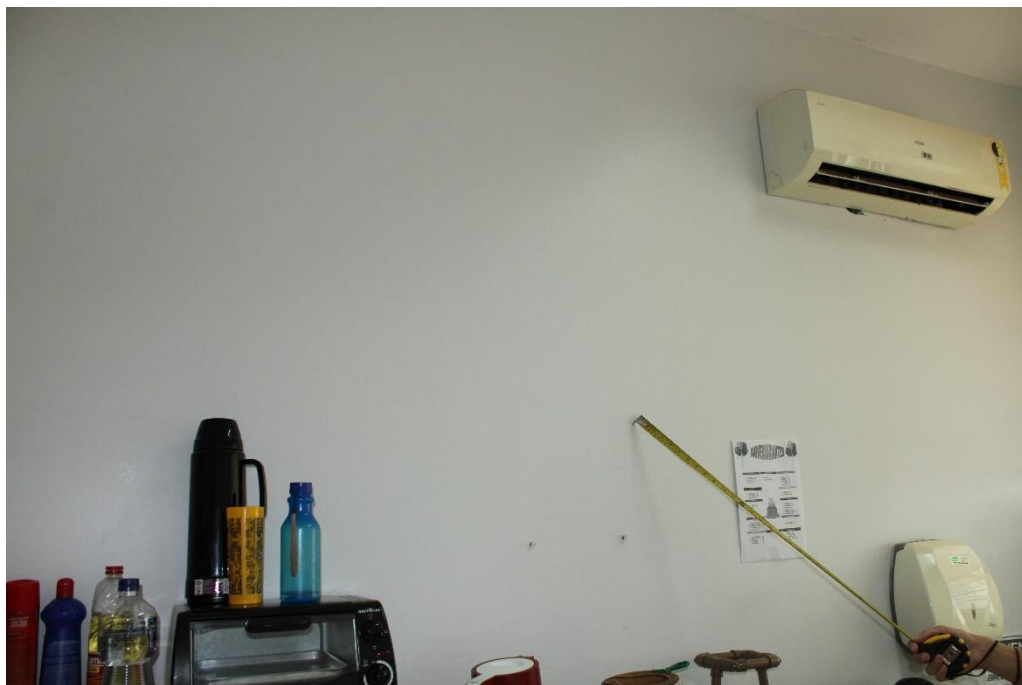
Vista parcial da sala 49, destacando fissura vertical em alvenaria.
